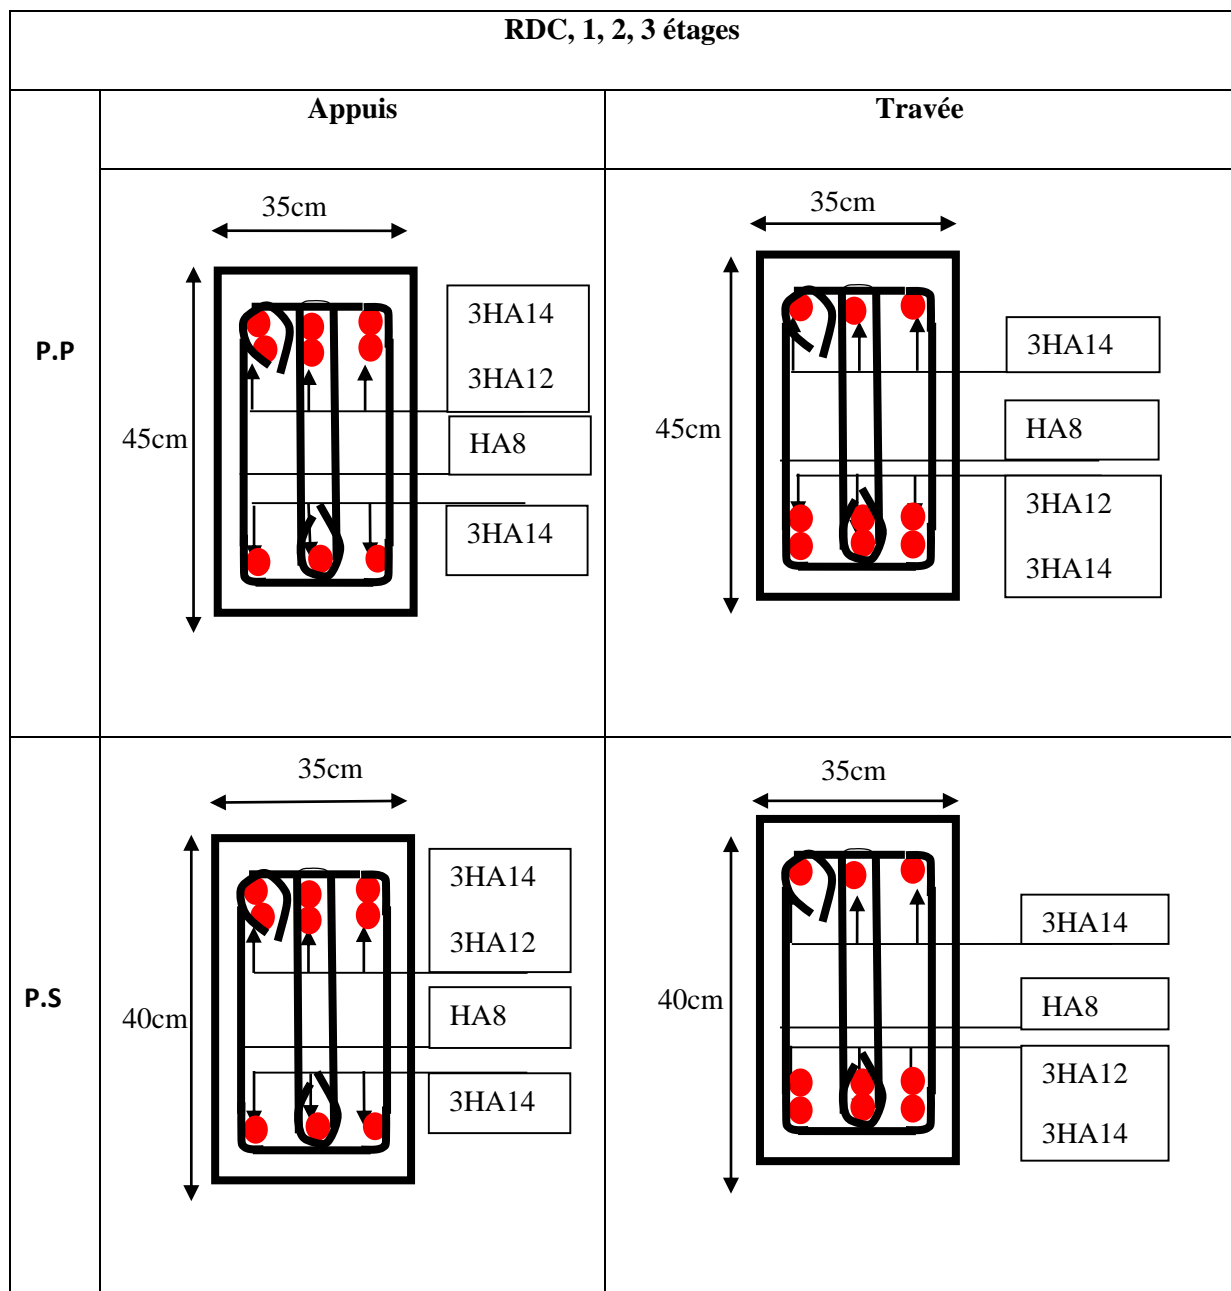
Schéma de ferrailage des poutres principales et secondaires du RDC et des étages
